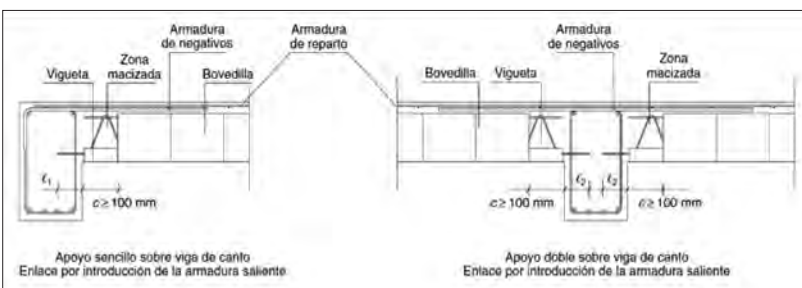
y 16: apoyo sobre viga de canto. Enlace por introducción de la armadura saliente.
